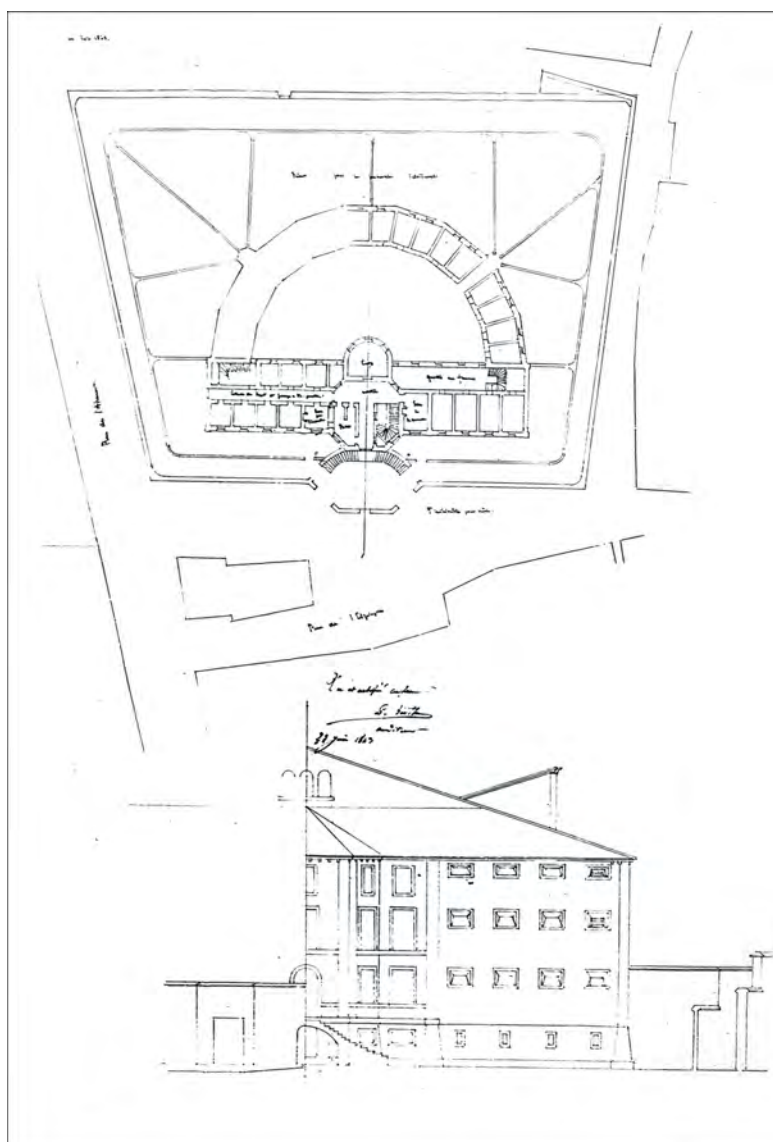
Plan du rez-de-chaussée et élévation du projet définitif avant les corrections (AN-F²¹1905, plans)
